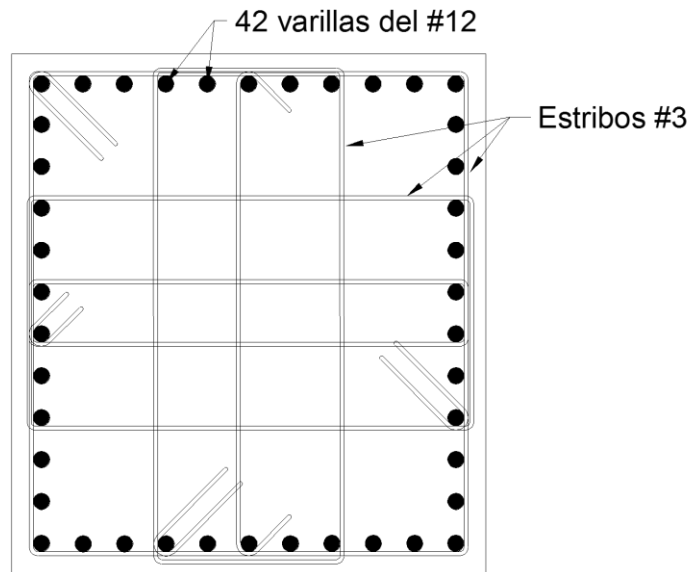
Detallado de refuerzo longitudinal y estribos para las columnas C4.
